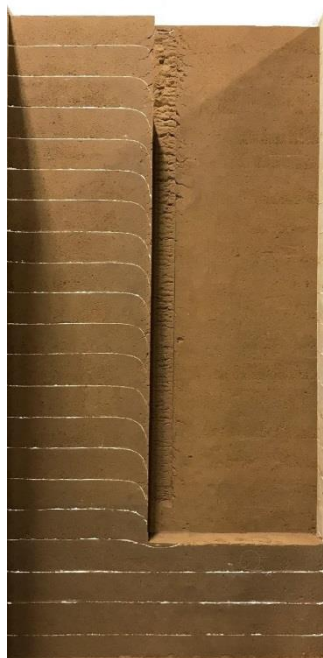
Разрушение несущего слоя грунта у боковой поверхности модели сваи после испытания на выдергивание
